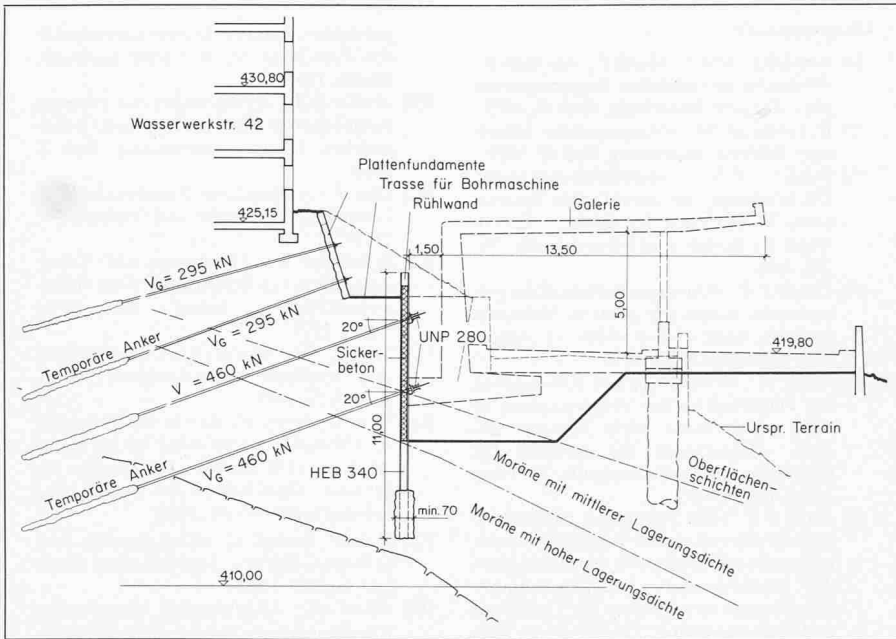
Schnitt durch die Baugrube mit projektierter Galerie
